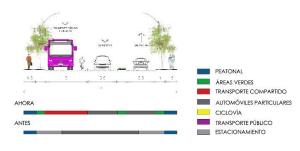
Propuesta de calle completa con sección vial de 12 metros CALLE COMPLETA: 12 METROS
